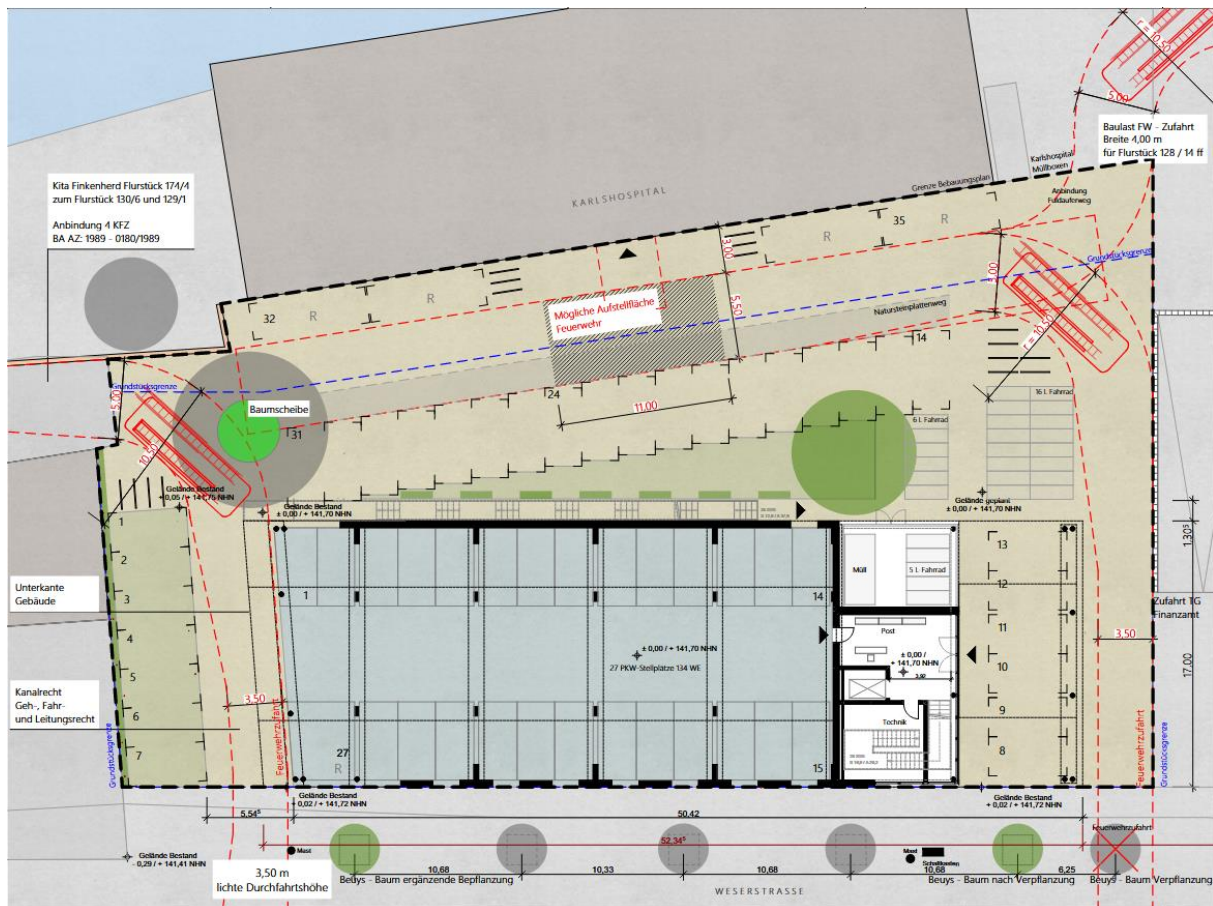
Lageplan unter Einbeziehung der Darstellung der zu beachtenden Baulasten für Feuerwehr und Hinterlieger
